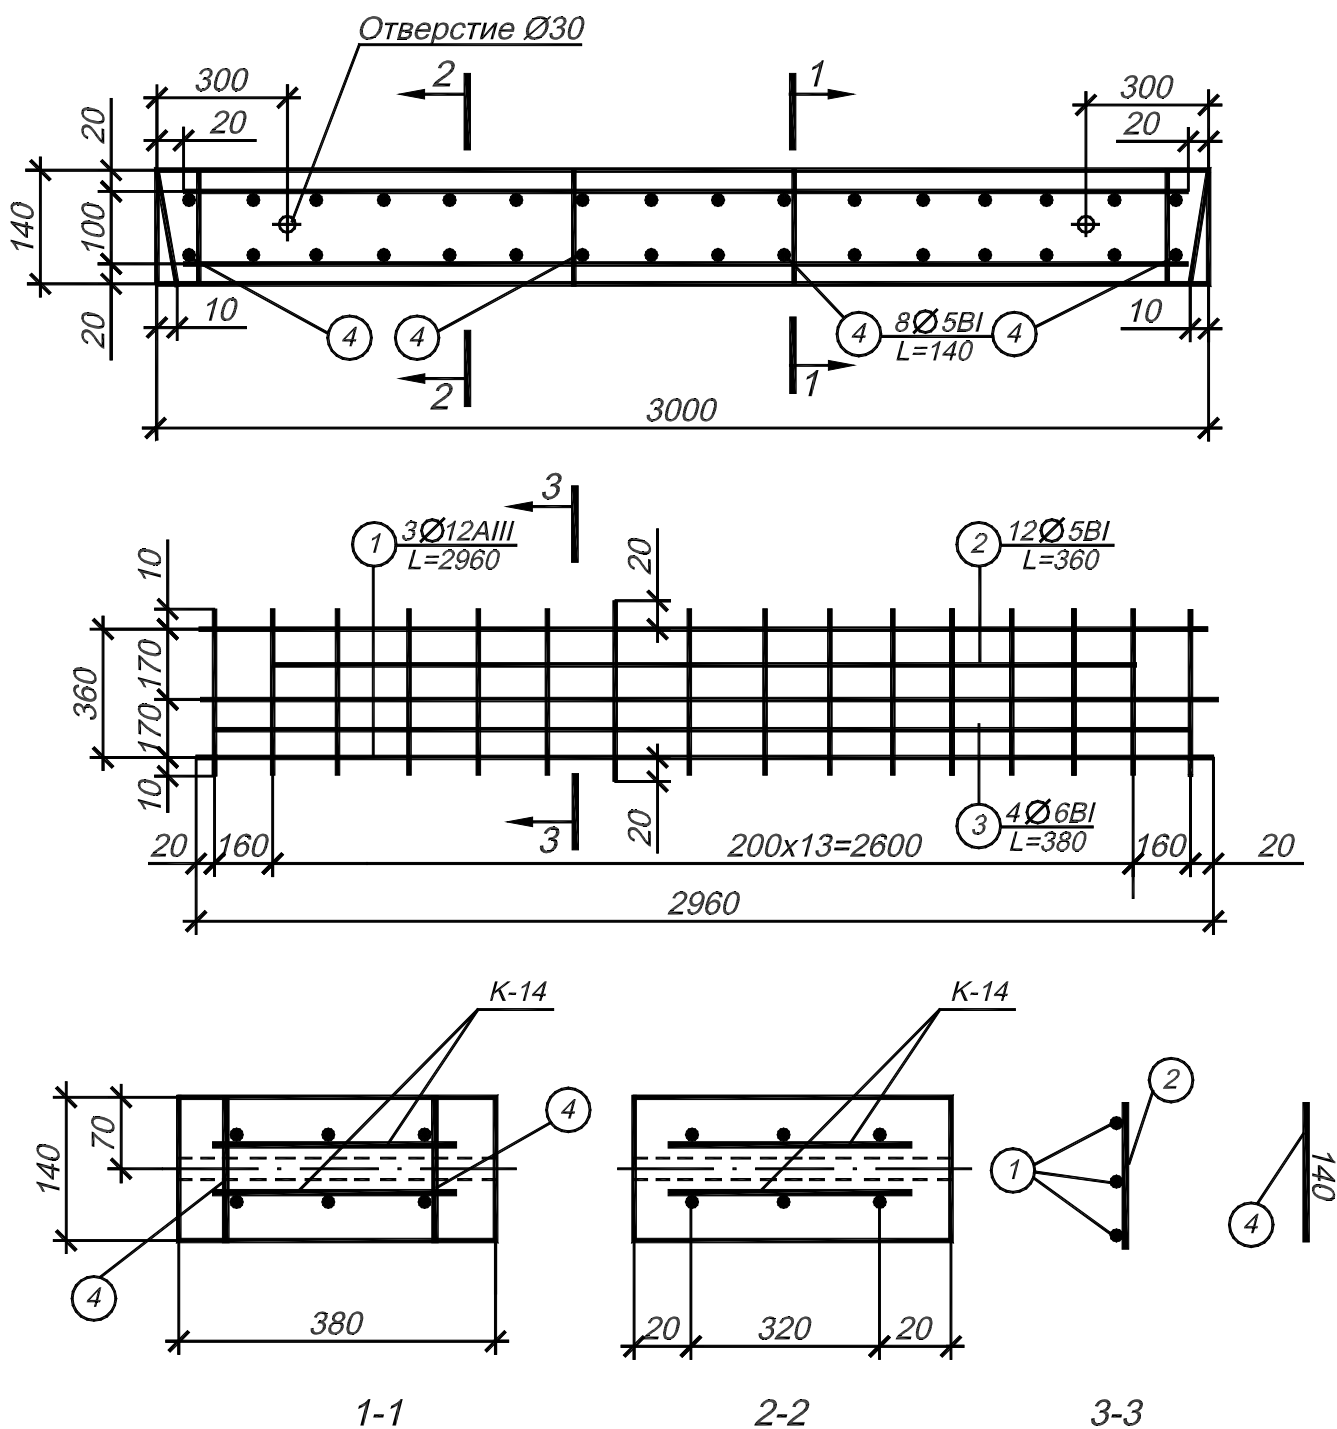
Варианты 26, 27, 28, 29, 30 задания «Железобетонные конструкции». Перемычка плитная БП 30
